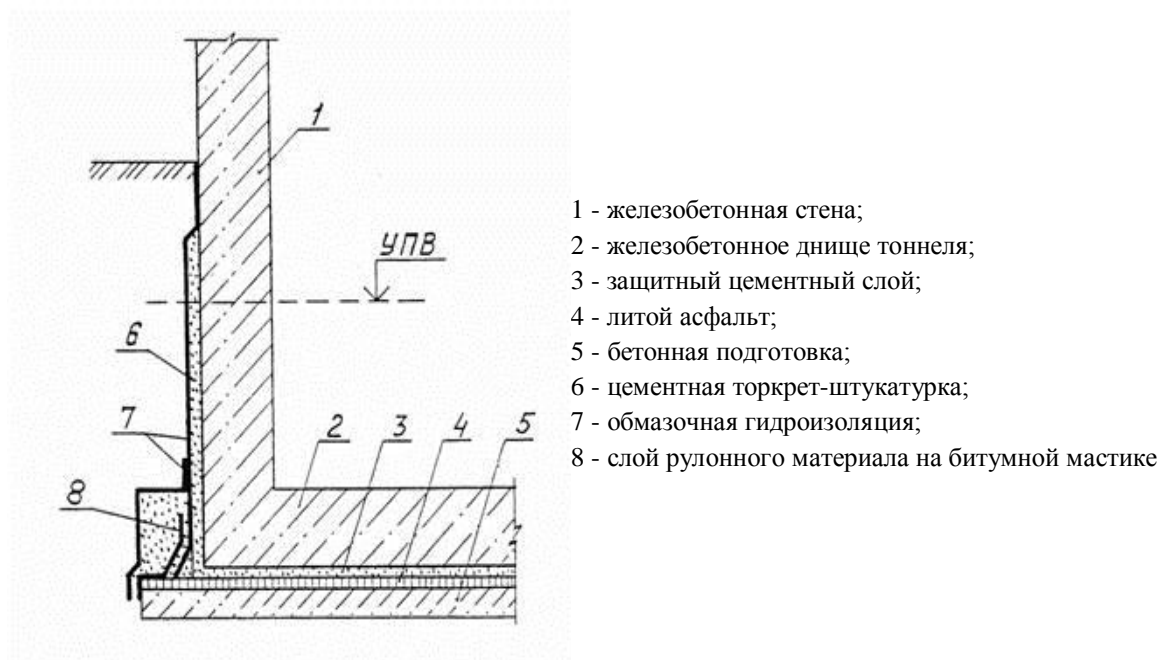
Штукатурная цементная гидроизоляция тоннеля при наличии подземных вод
